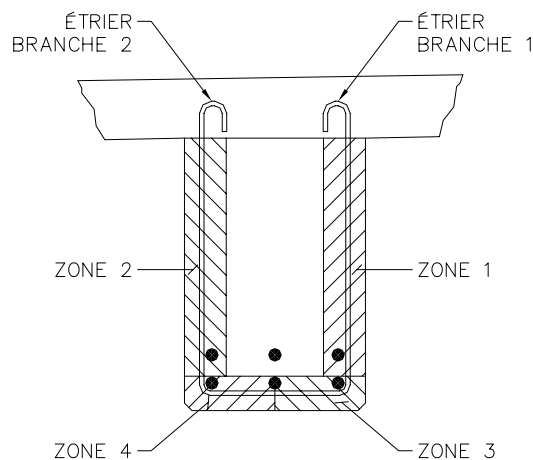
Définition des zones d'endommagement d'une poutre
